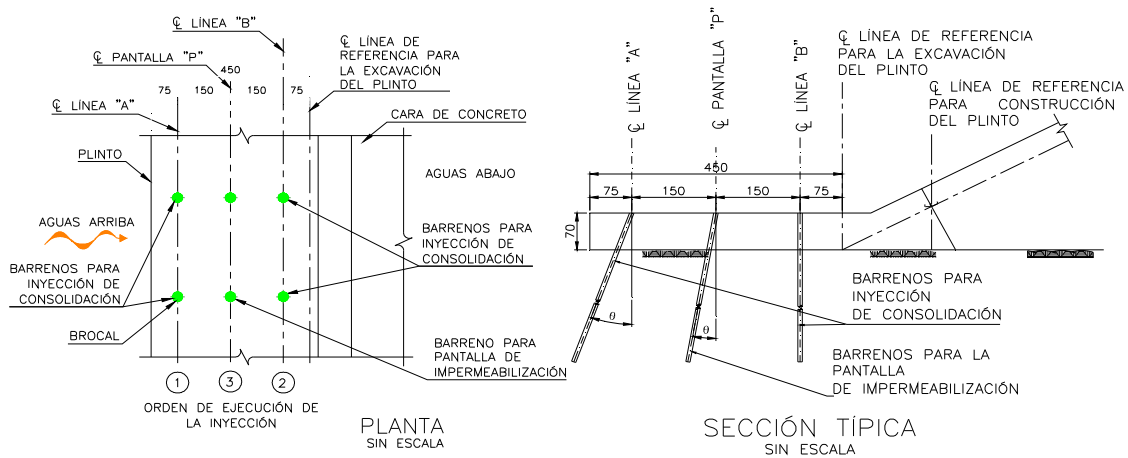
Planta y sección del Plinto y distribución de los barrenos de inyección en el tramo P5-P6.
